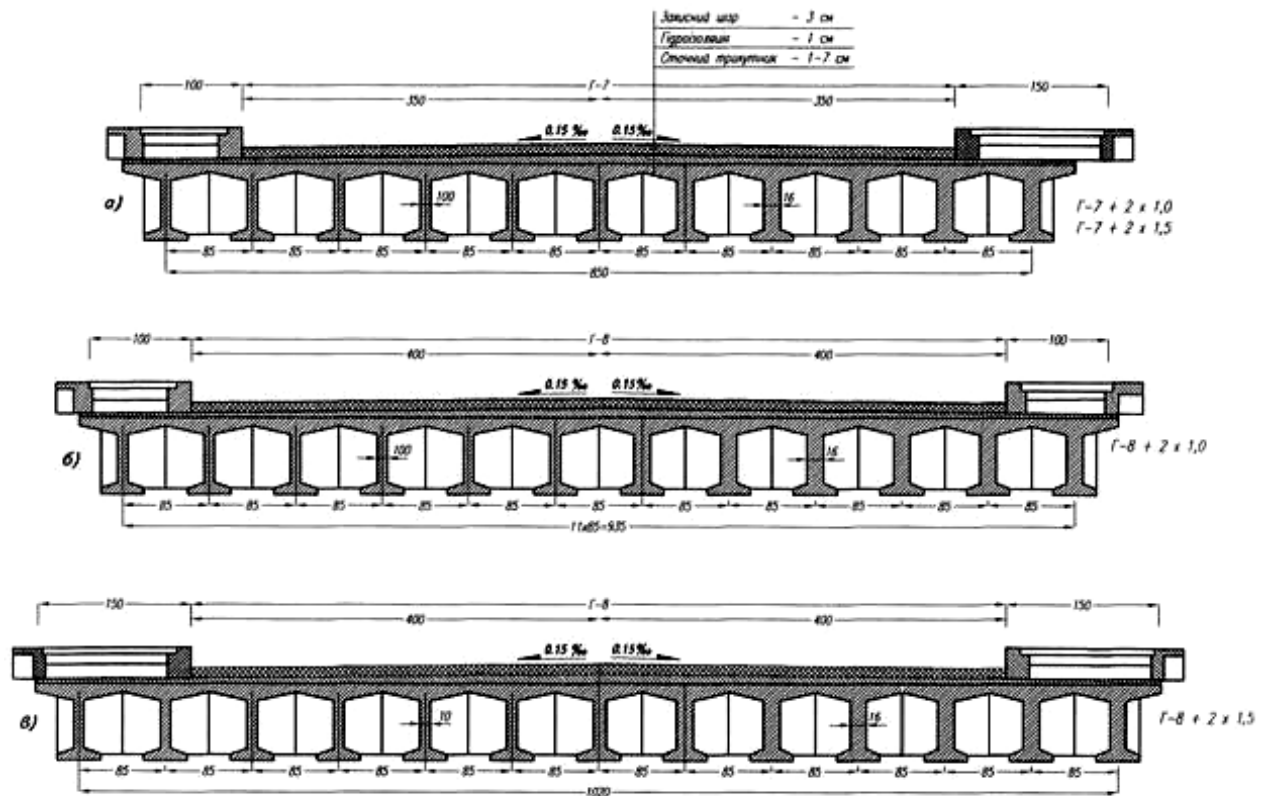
Типові поперечні перерізи струнобетонних прольотних будов $l=11,36$ і $16,76$ м
